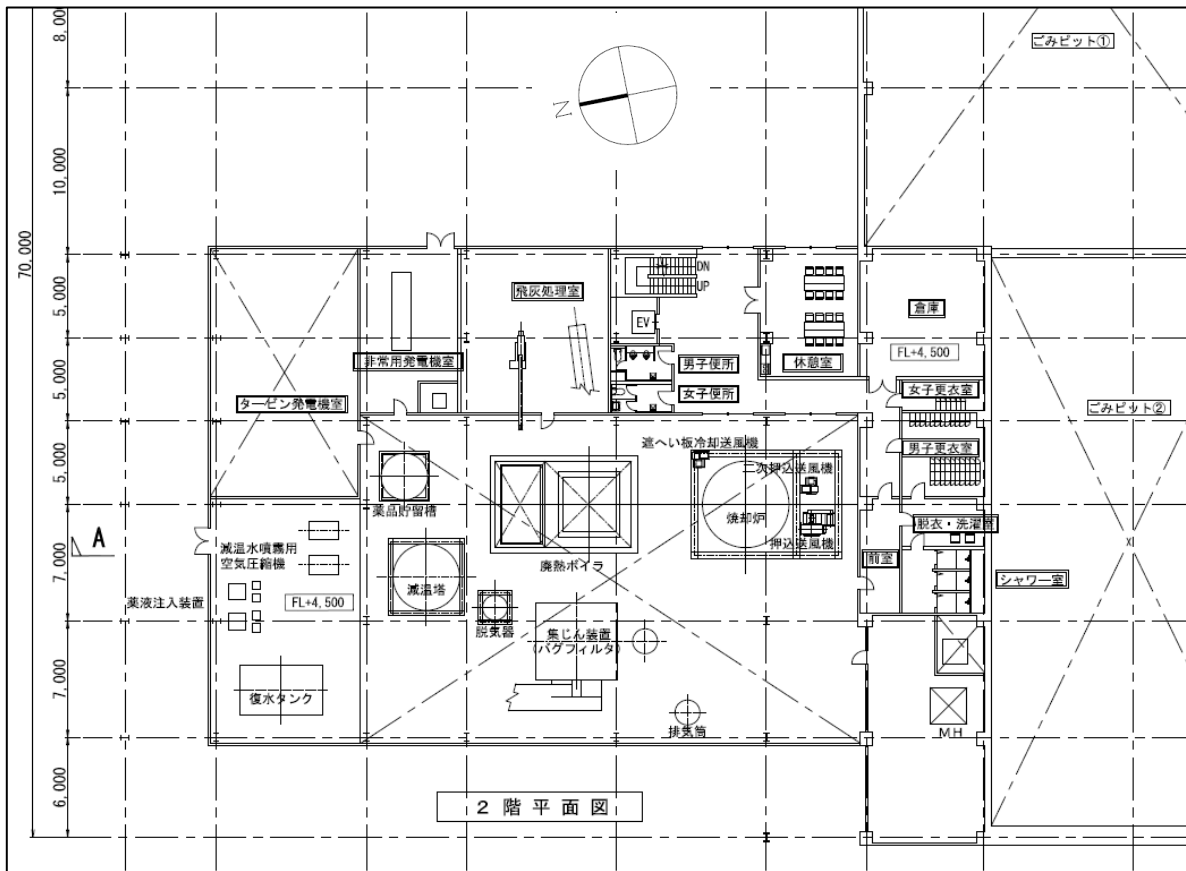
(2) 設備配置図 (焼却施設 2 階)
